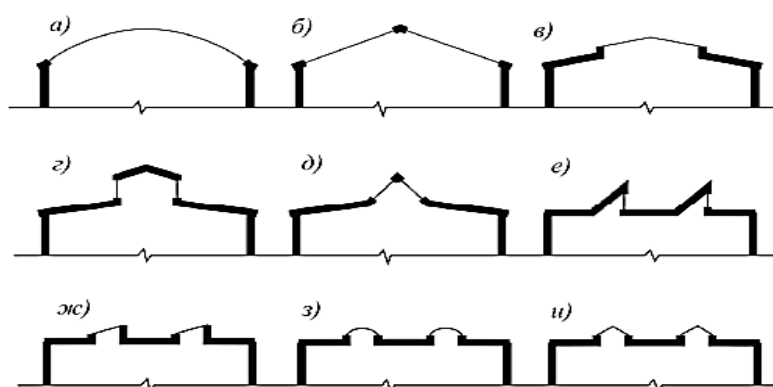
Основные схемы светопропускающих покрытий в зданиях
